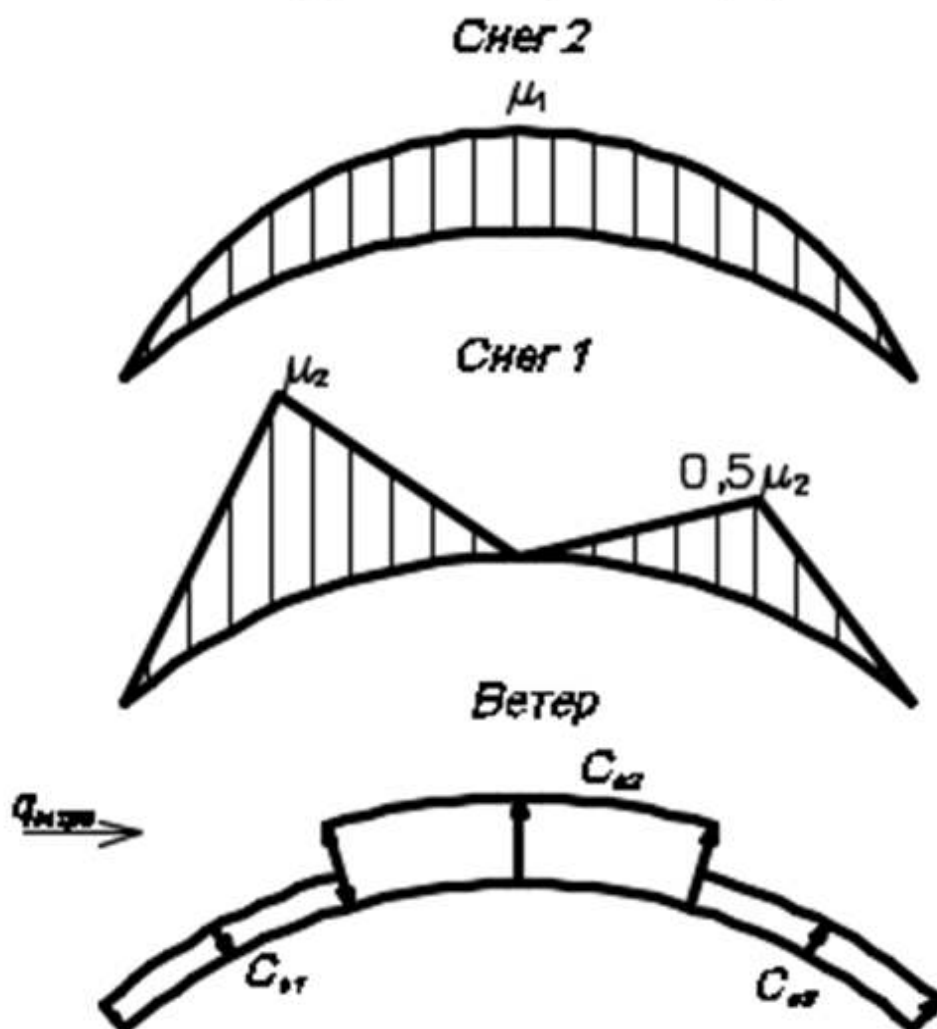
Нагрузки на двухслойное арочное покрытие
